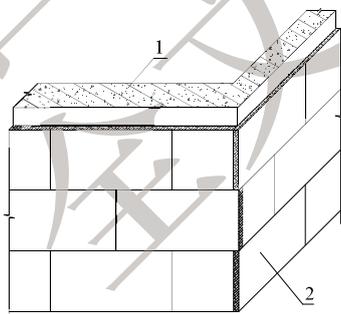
墙角保温板排板示意（尺寸单位：mm）
